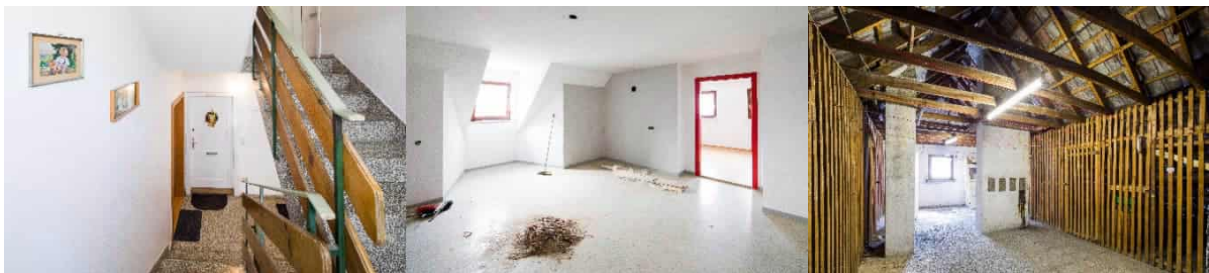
Gebäudetyp groß, Treppenhaus, Dachgeschoßwohnung und unbeheizter Teil des Dachgeschosses (Fotos: Walser Fotografie, Hohenems)
